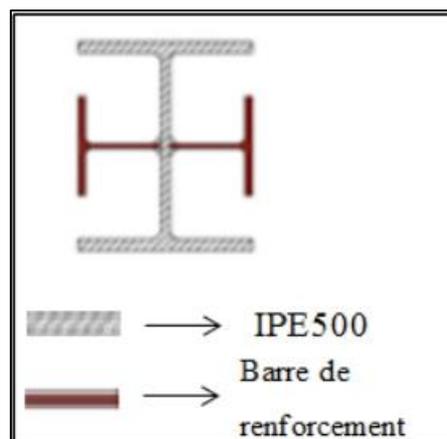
SYSTEME STRUCTUREL POTEAU IPE 500
